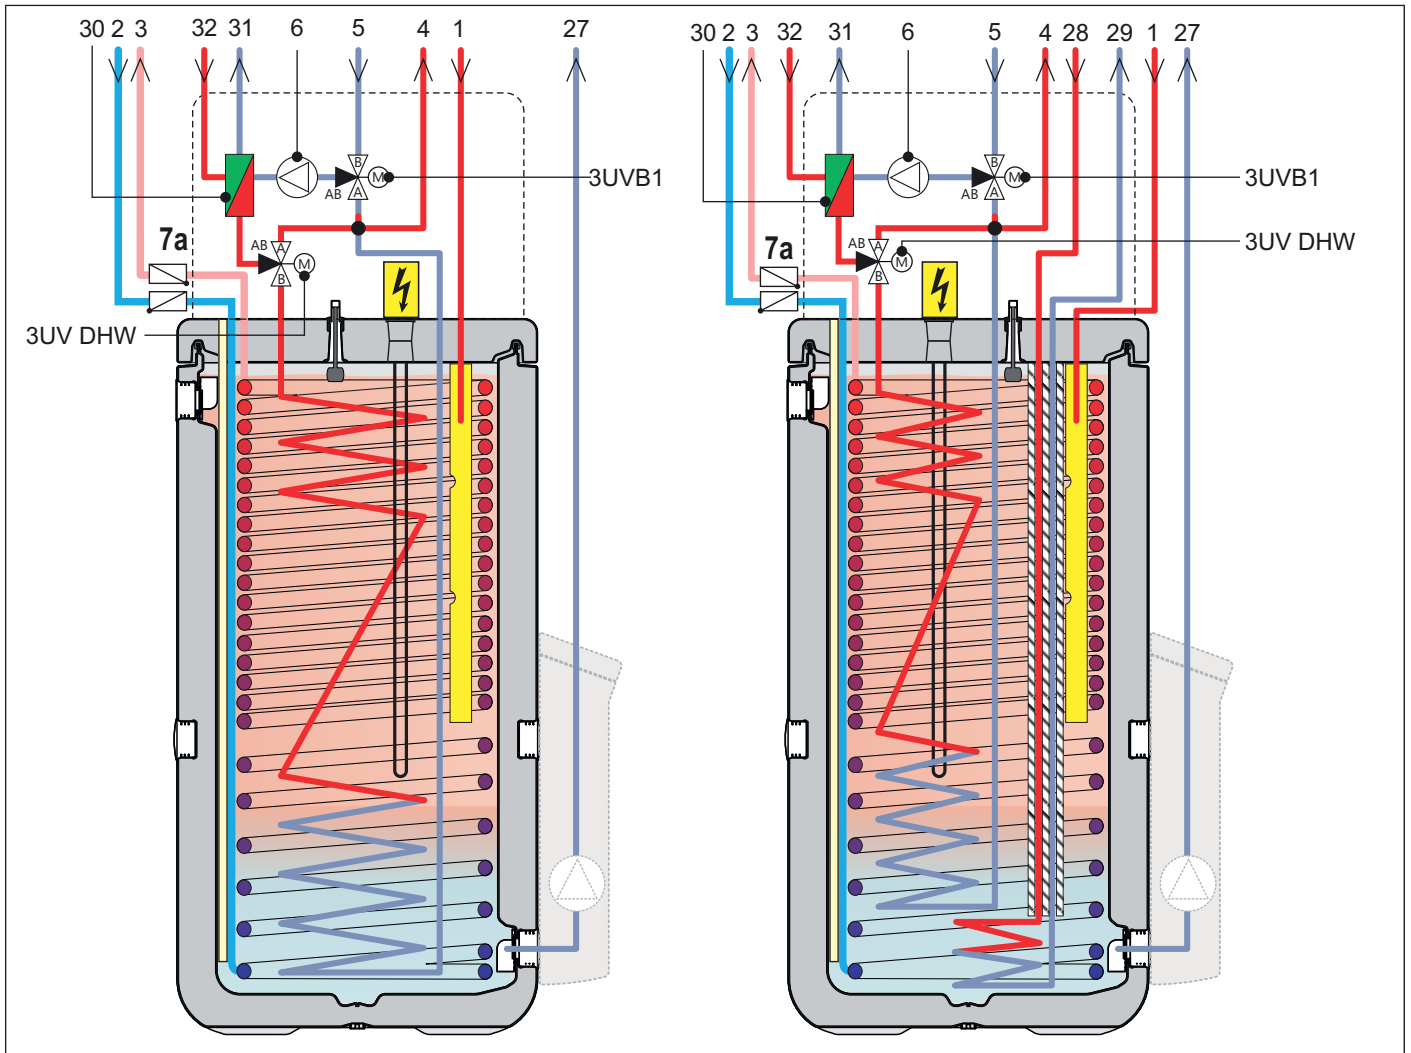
Hydraulischer Aufbau - Innengeräte HPSU compact 516
